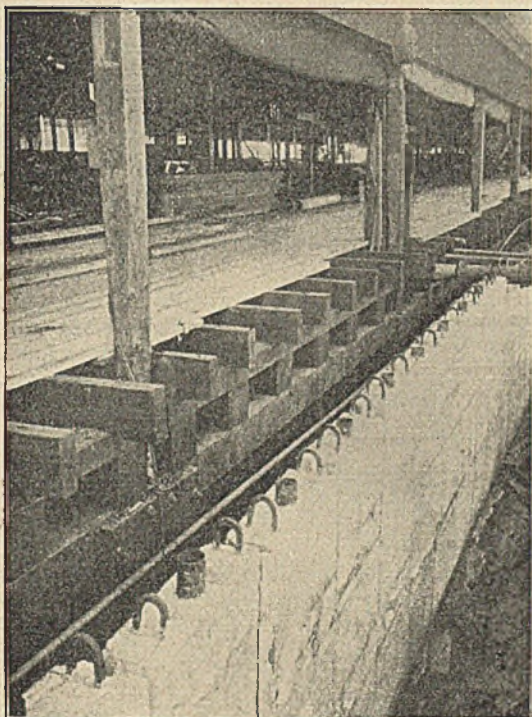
Eisenbetonspundwand für das Stuyvesant-Dock in New York.
